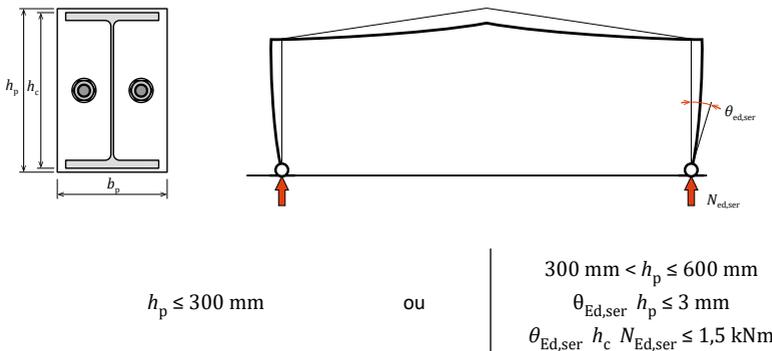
Critères conventionnels pour un pied de poteau articulé
